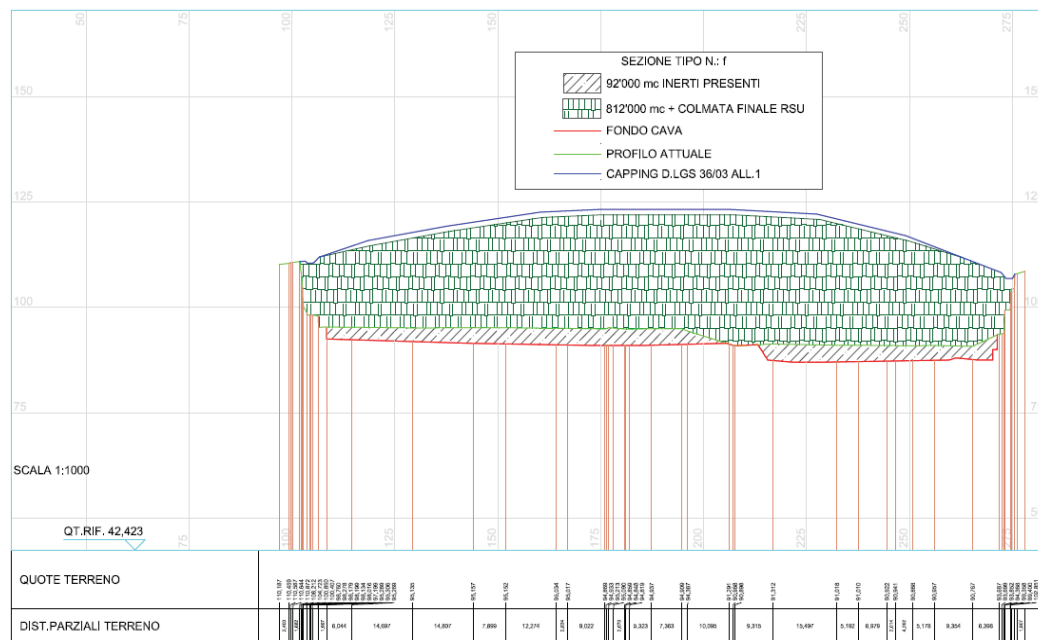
Stralcio della tavola allegata con il profilo di chiusura
